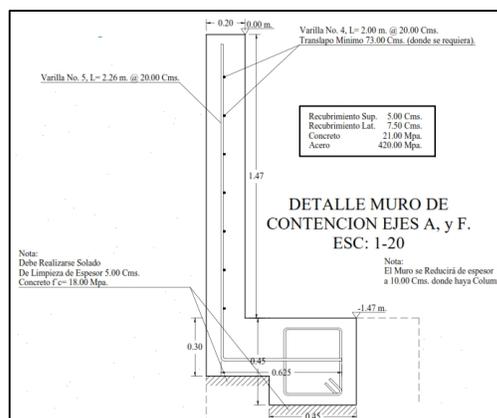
, Detalle muro de contención ejes A, y F. Fuente: Constructora Open House.
